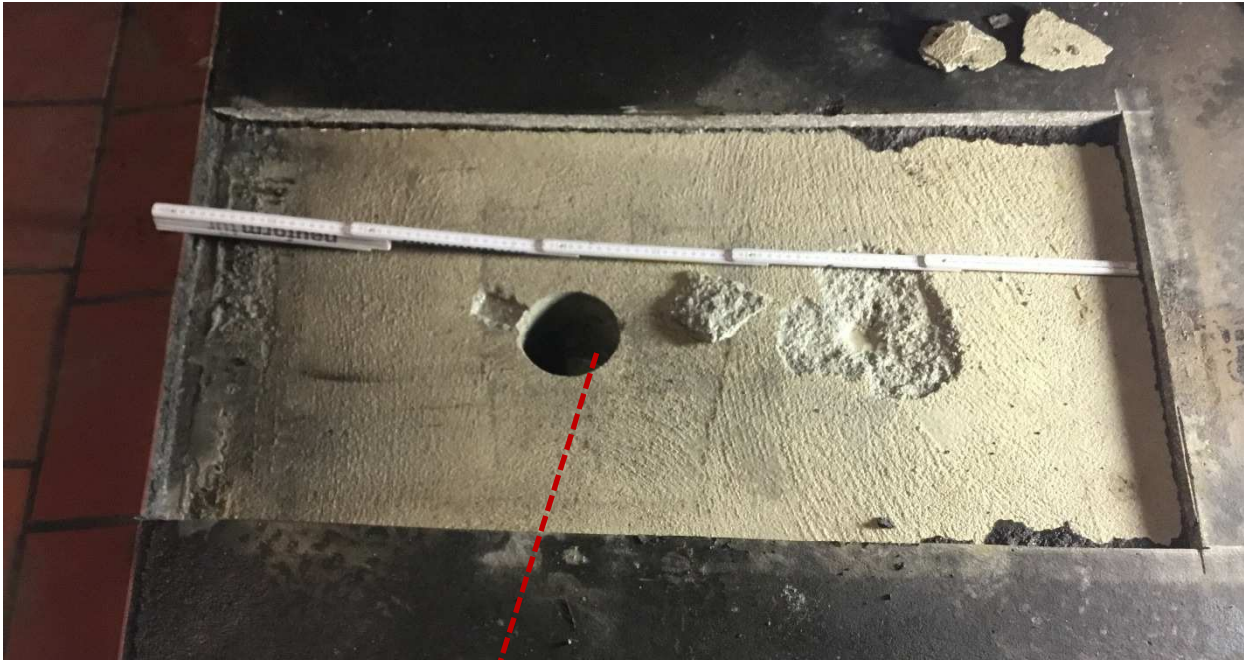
Bauteilöffnung Nr. 34 [A] 6 am Tiefgaragenboden neben der Rinne. Der Tiefgaragenboden ist durchgehend mit einem Gussasphaltbelag belegt. Unter dem Gussasphalt befindet sich ein Estrich der im Gefälle zur Entwässerungsrinne (Tiefpunkt) verlegt ist.
